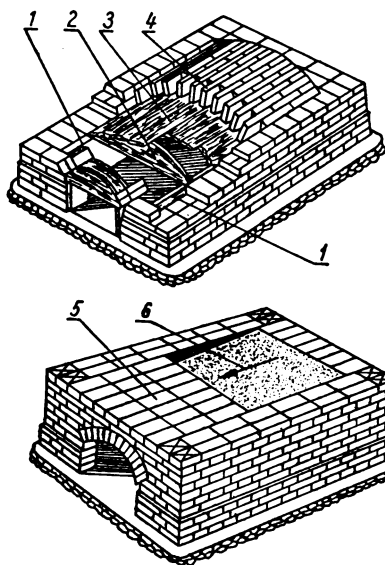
Кладка 5—7-го и 10—20-го рядов русской печи:
